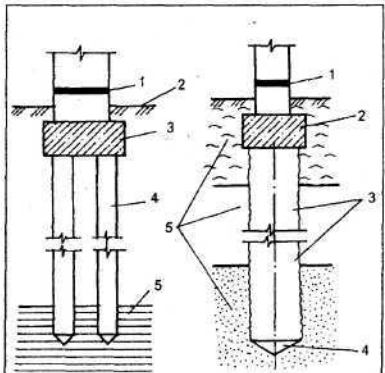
Забивная свая. Рис. 8. Набивная свая. Стойка фундамента: висячая свая фундамента:
